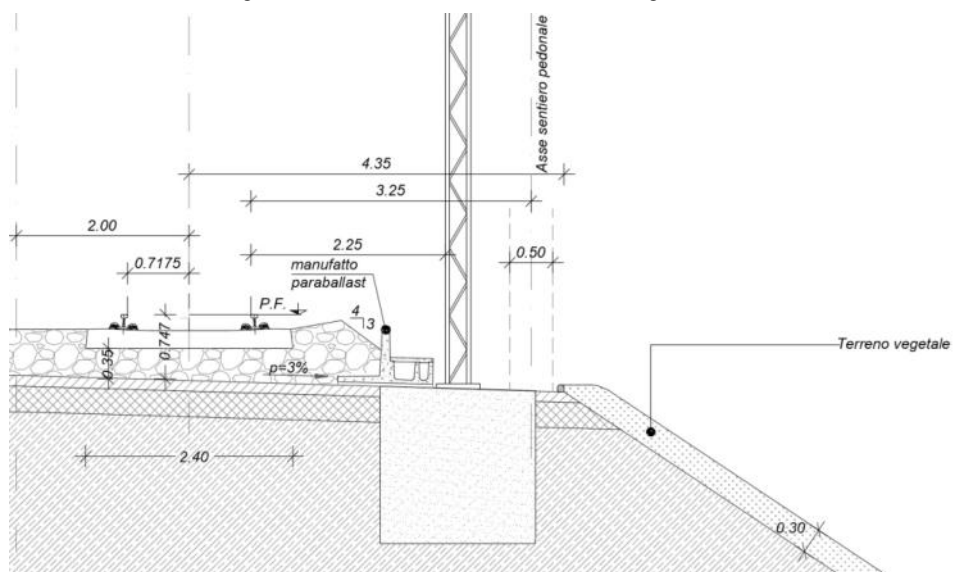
Sezione ferroviaria in rilevato - dettaglio
